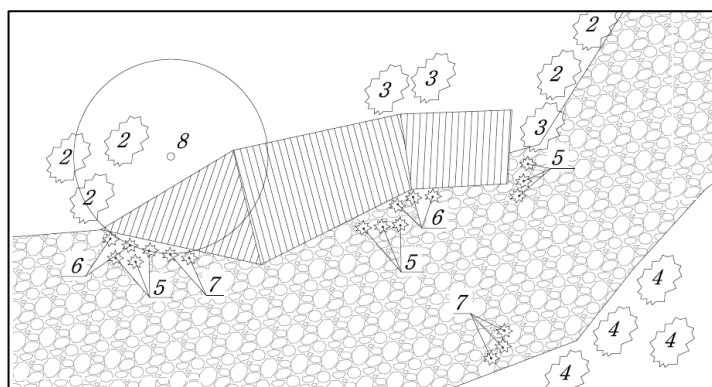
Фрагмент генплана 8, схема посадки растений для зоны «сухого ручья»
